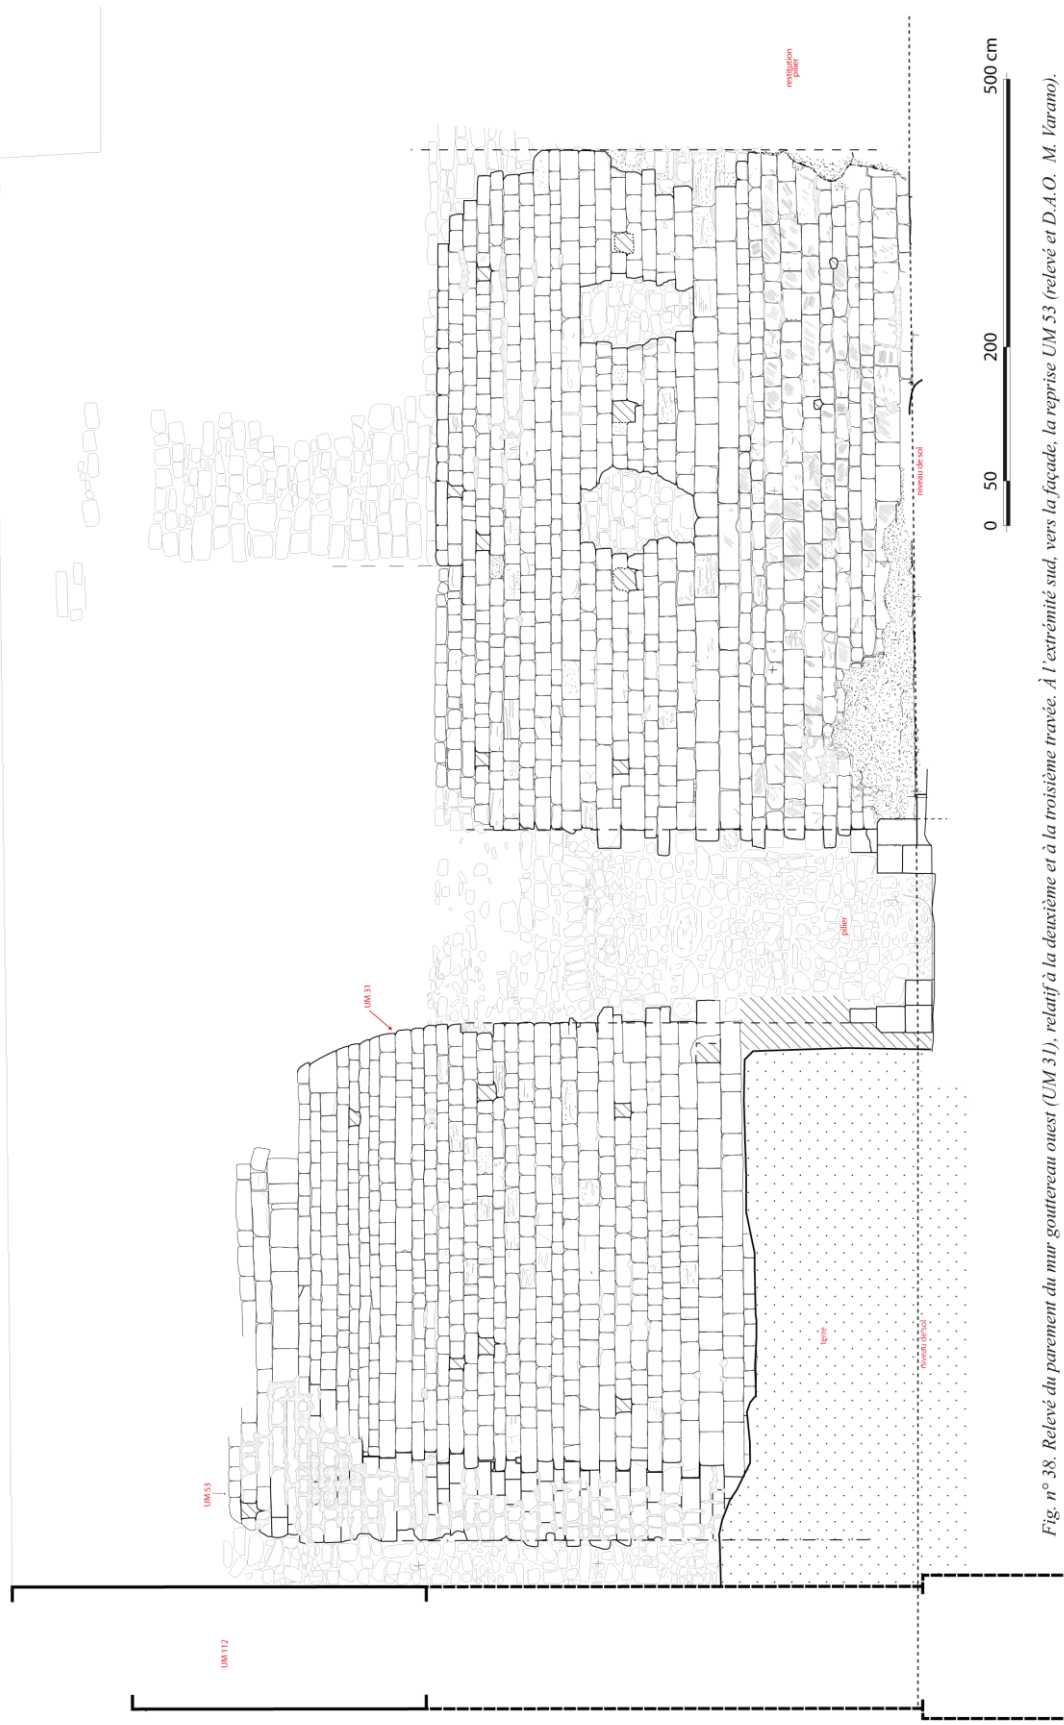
Relevé du parement du mur gouttereau ouest (UM 31), relatif à la deuxième et à la troisième travée. À l'extrémité sud, vers la façade, la reprise UM 53 (relevé et D.A.O. M. Varano).
